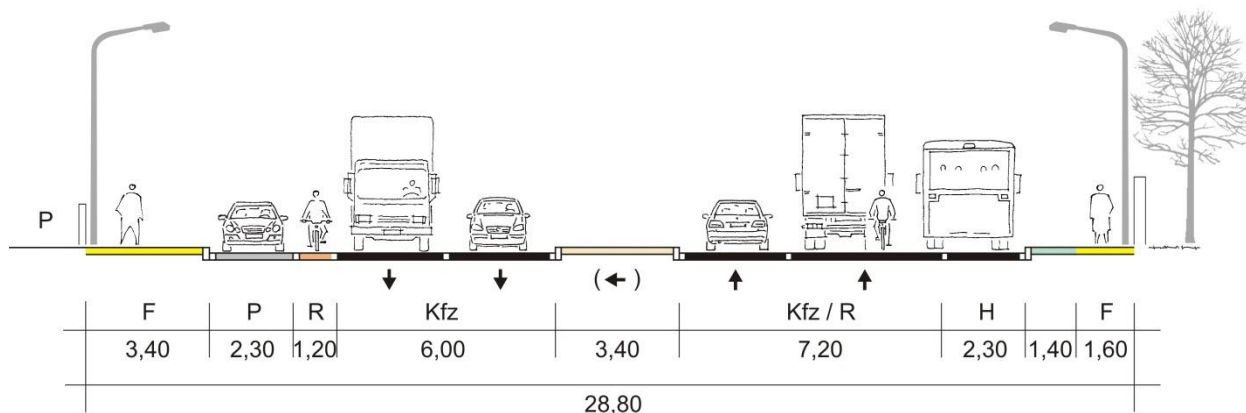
Bestandsquerschnitt B-B Mindener Straße (östlich Rawiestraße)
